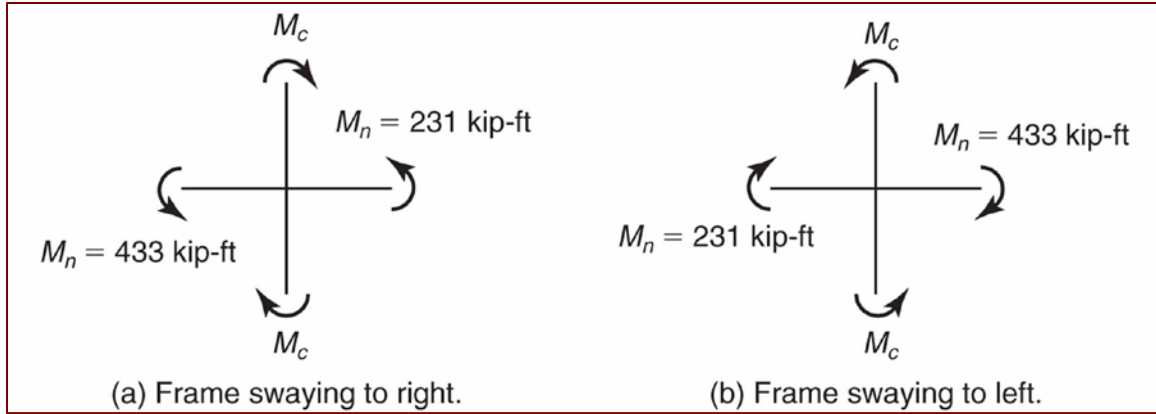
Momentos en una junta viga – columna—Ejemplo 12-2.
